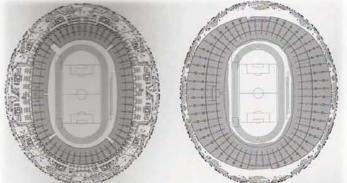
Plantas arquitectónicas, la de la izquierda muestra la planta baja o de acceso, y la de la derecha el de graderías totales.
